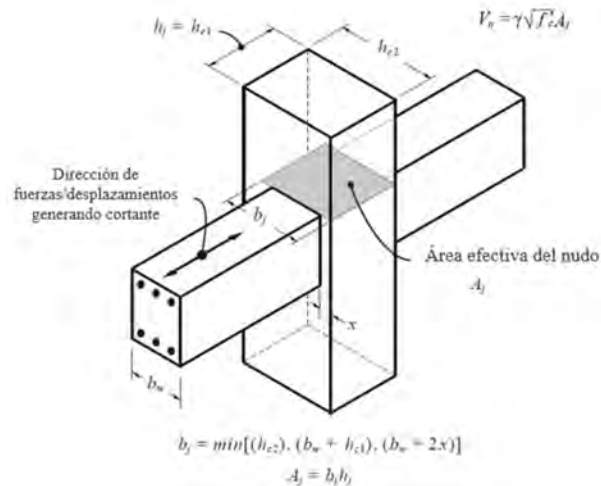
Definición de dimensiones viga-columna. Fuente: NIST GCR 16-917-40, 2016.
